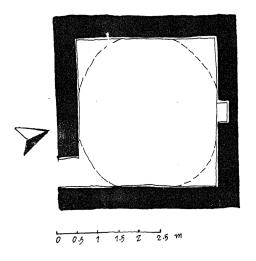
ضريح الحاج اسماعيل - مسقط أفقى
